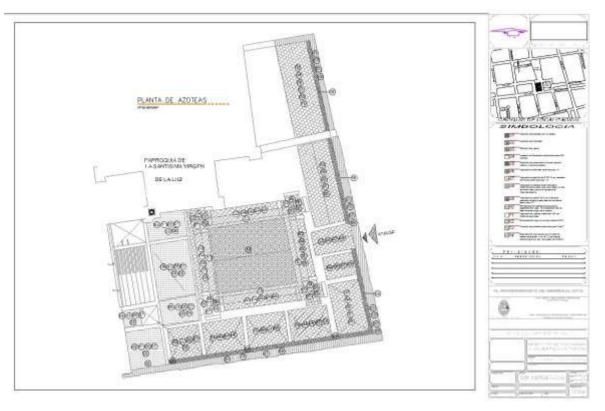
Planta de azoteas intervención. Eloísa Galván González. 2014
